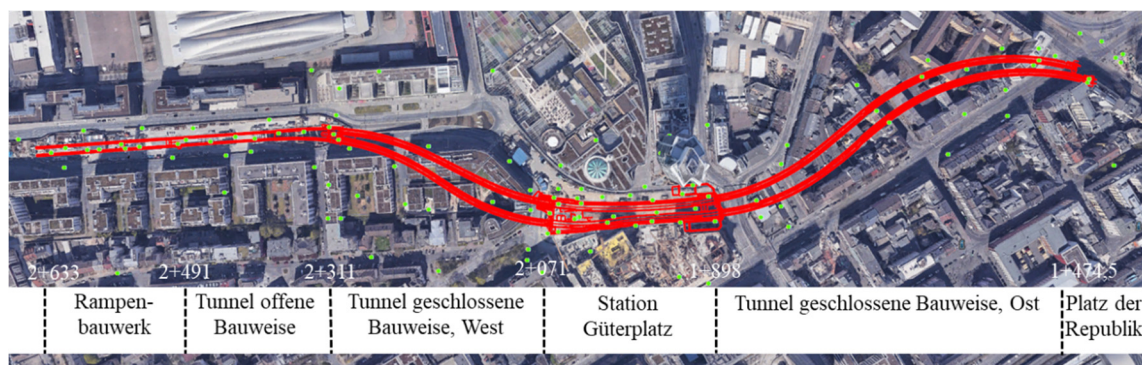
Lageplan mit Streckenverlauf (rot) und Baugrundaufschlüssen (grün)
